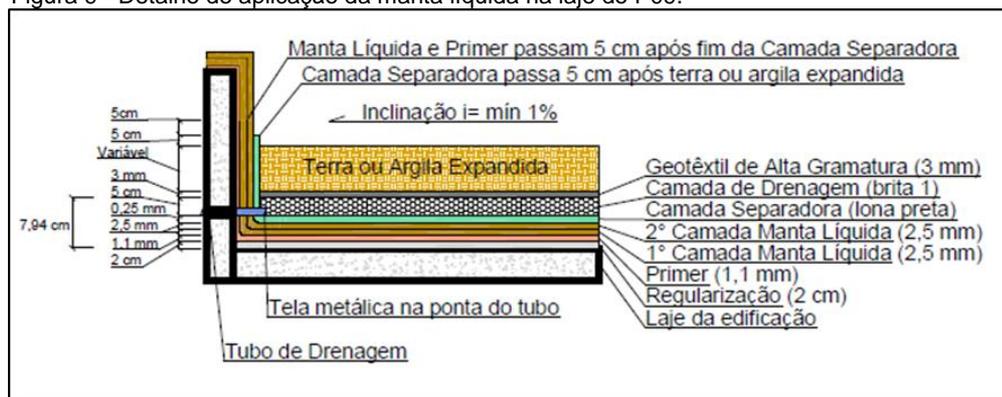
Detalhe de aplicação da manta líquida na laje do P09.
